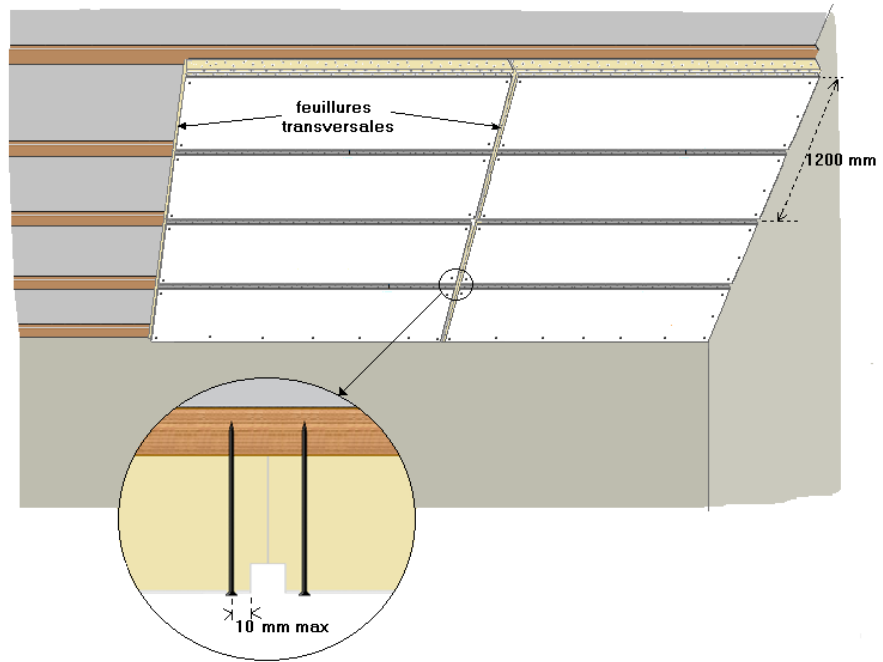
Aboutage des panneaux EFICHOCE PLAFOND
